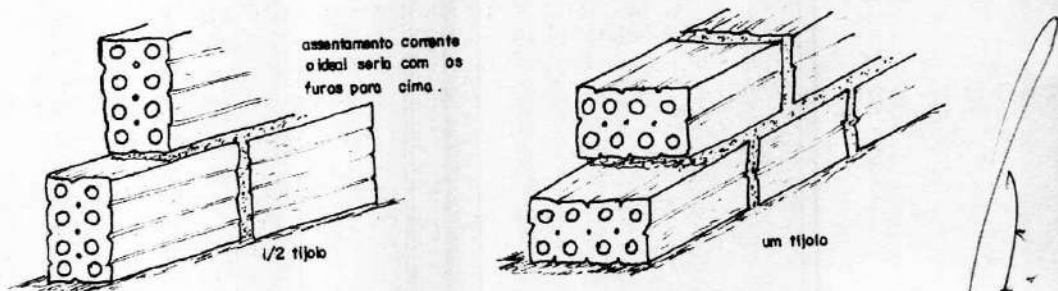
Execução de alvenaria utilizando tijolos furados.
